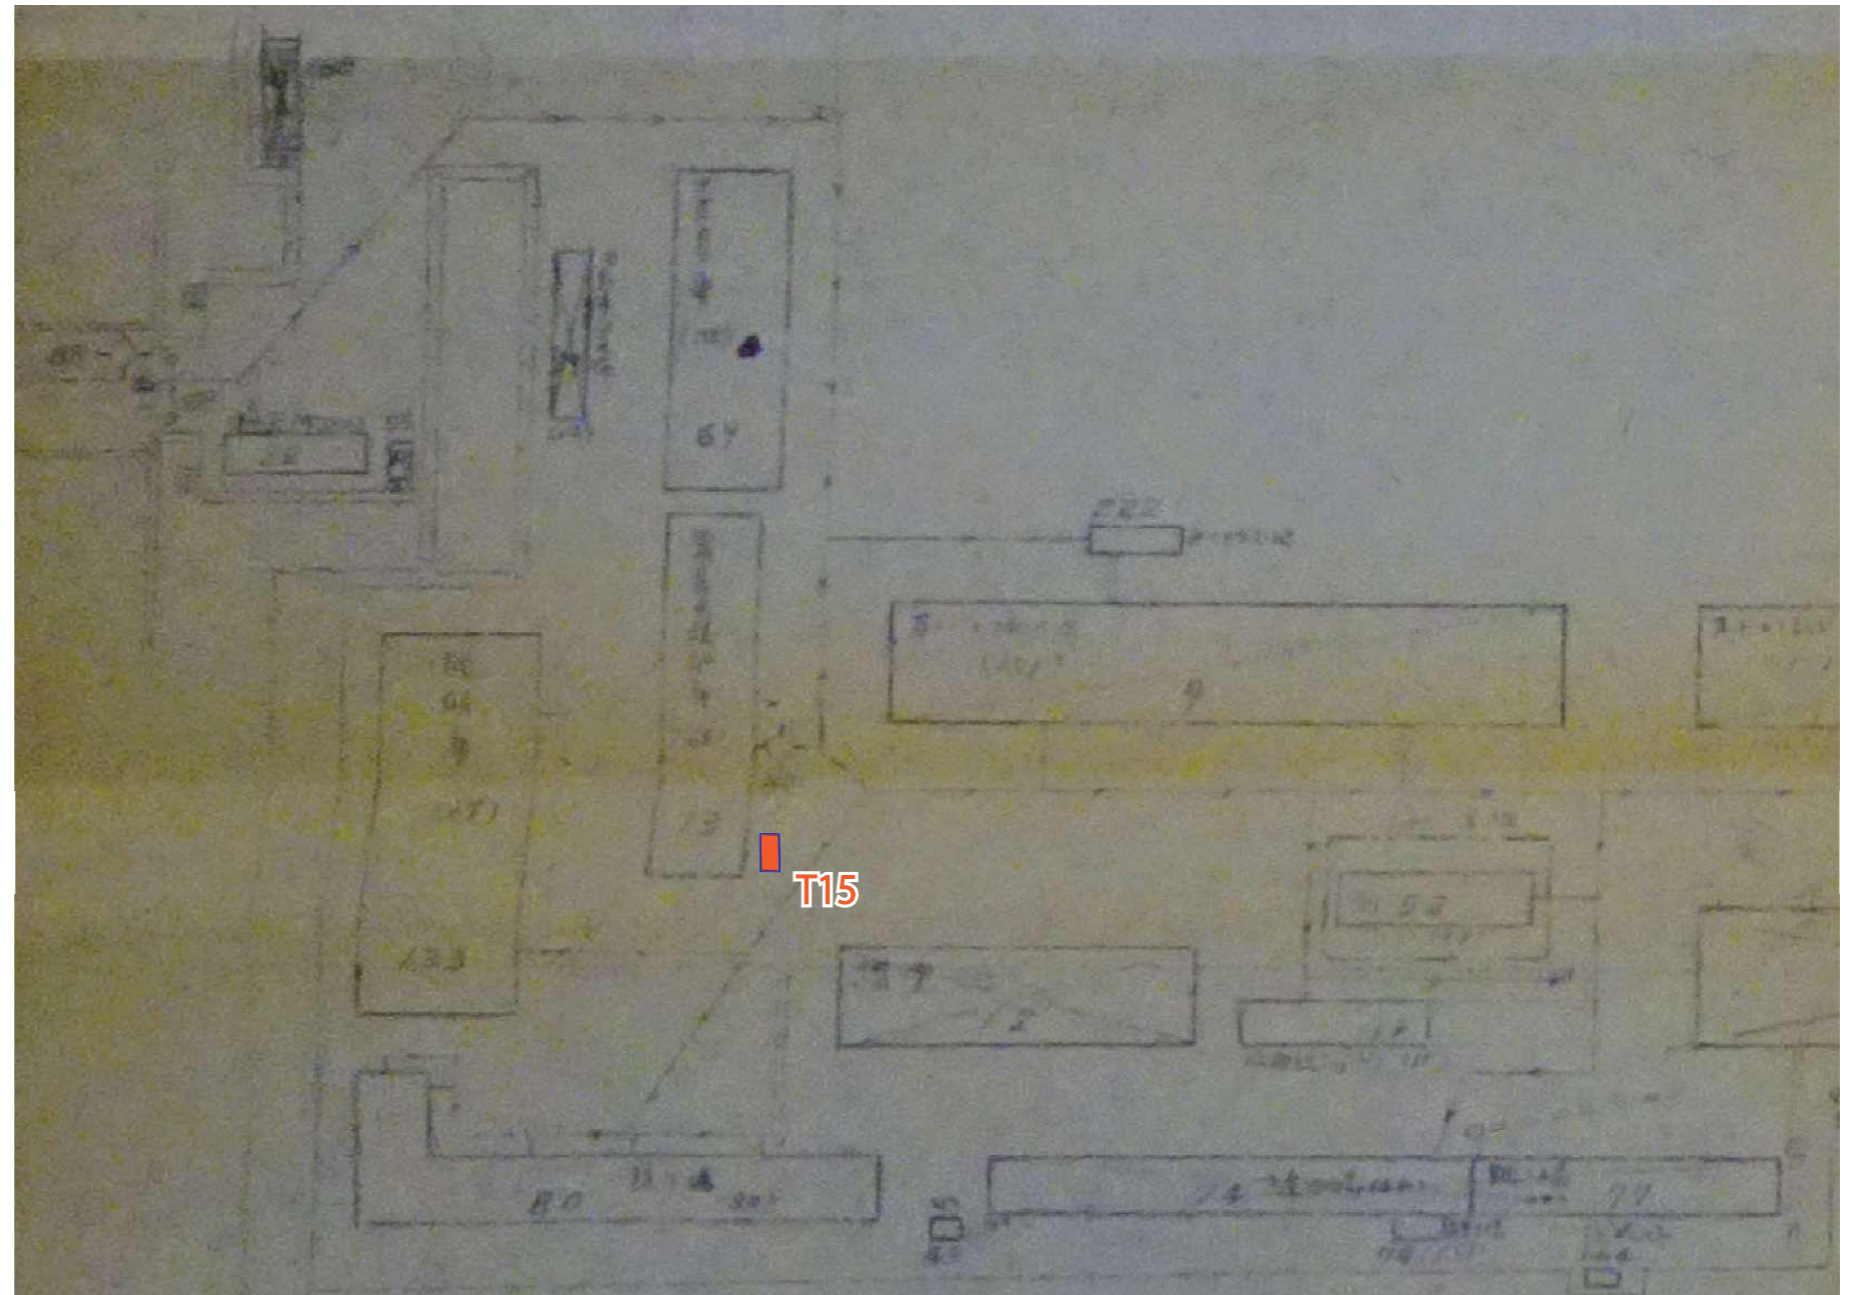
博物館 明治村所蔵「歩兵第六連隊平面図集 平面図」拡大図2
